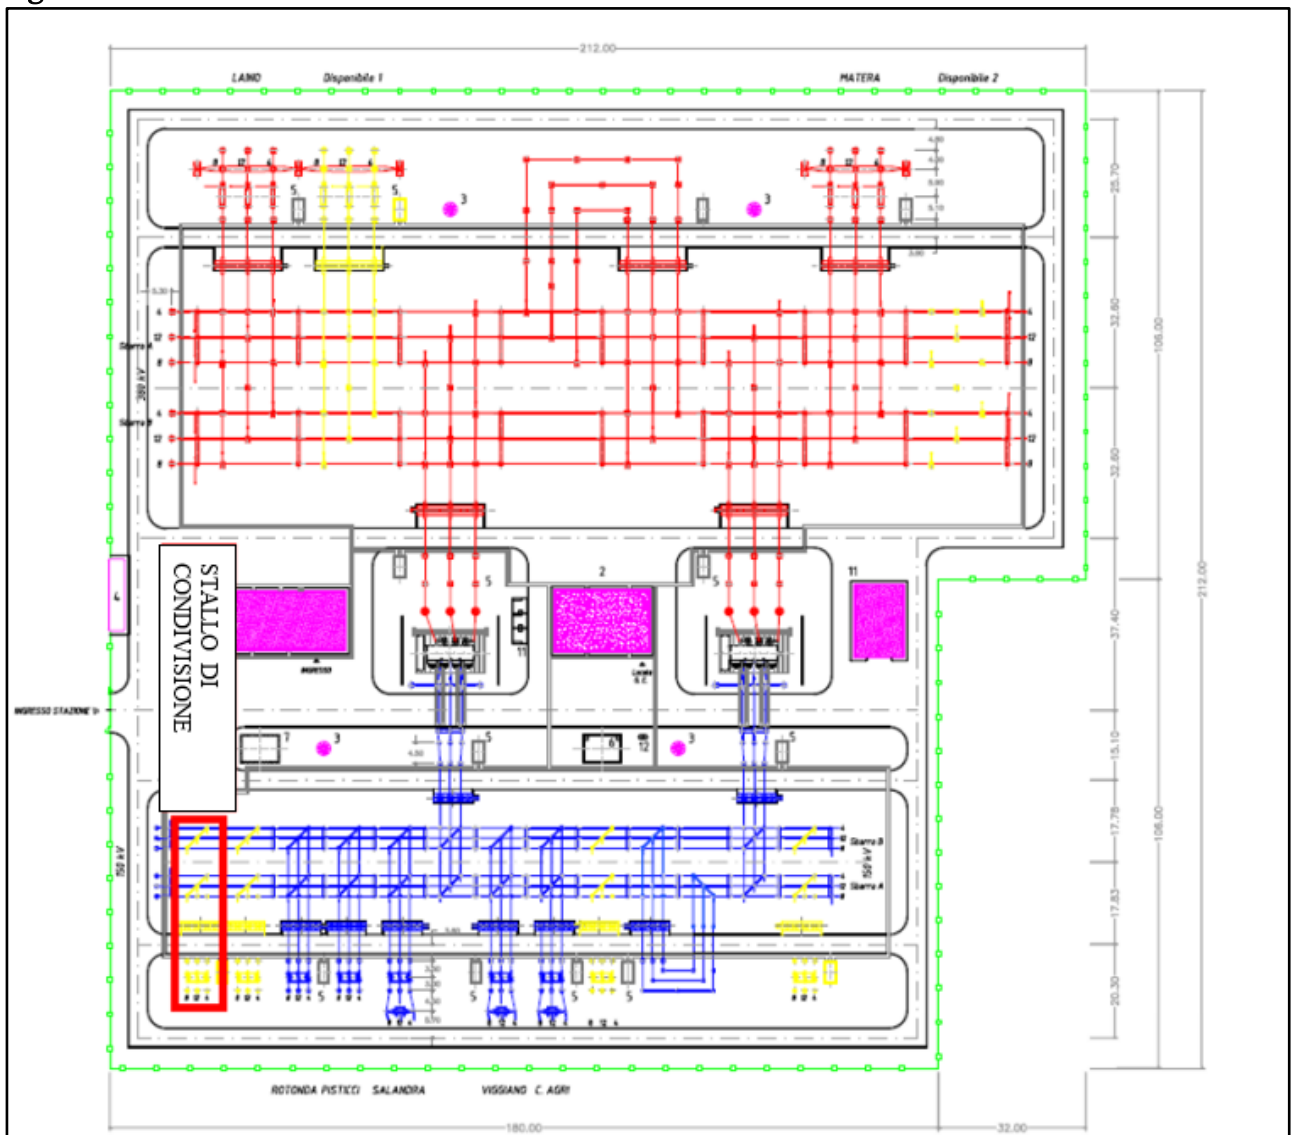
Planimetria della SE RTN a 380/150 kV con l'ubicazione dello stallo condiviso
